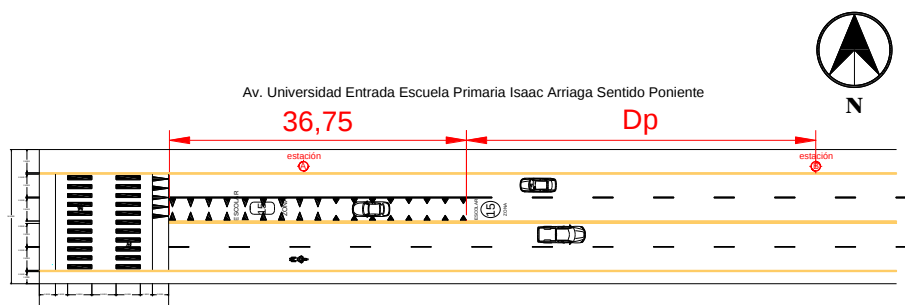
Planta geométrica de la zona escolar 03. Elaboración propia
